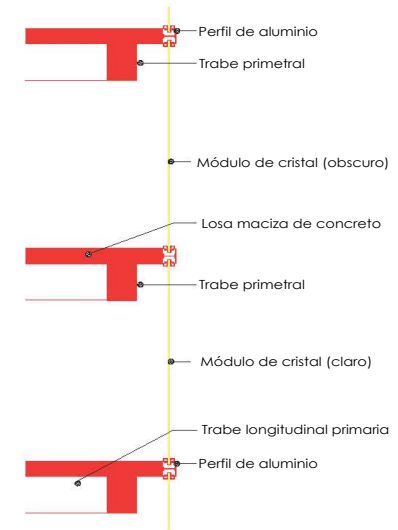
Corte por fachada de volumen 1. Fuente: creación propia.
